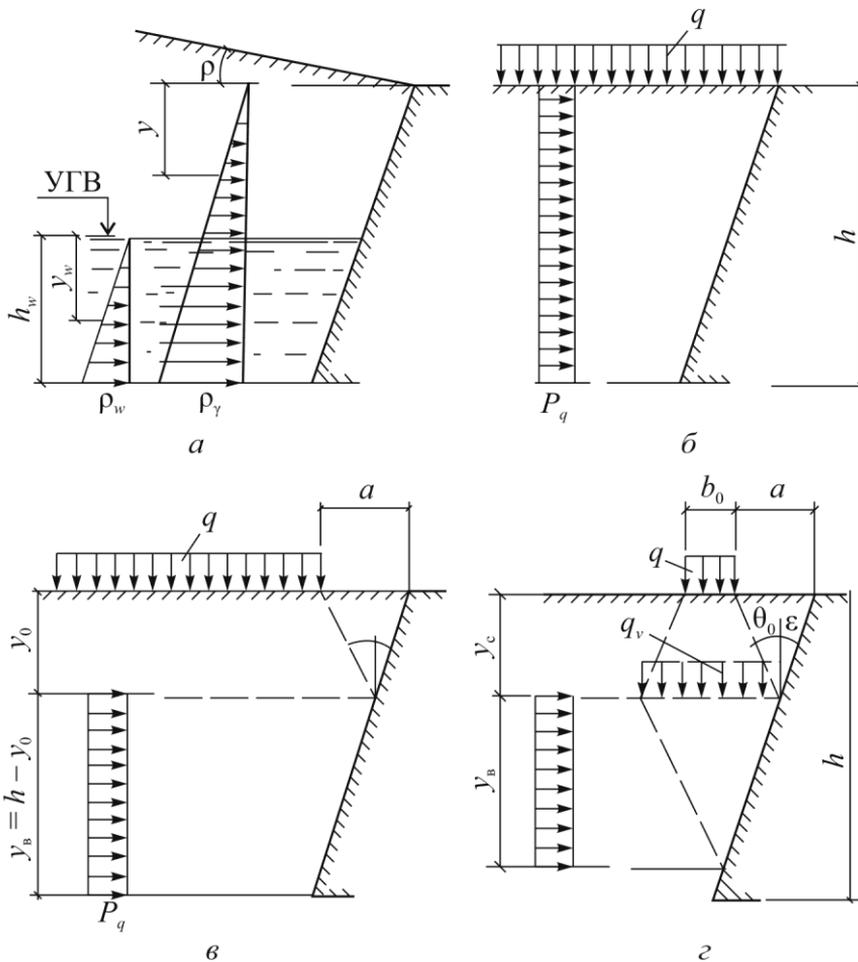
Схема давления грунта: *a* – от собственного веса и давления воды; *б* – от сплошной равномерно распределенной нагрузки; *в* – от фиксированной нагрузки; *г* – от полосовой нагрузки
